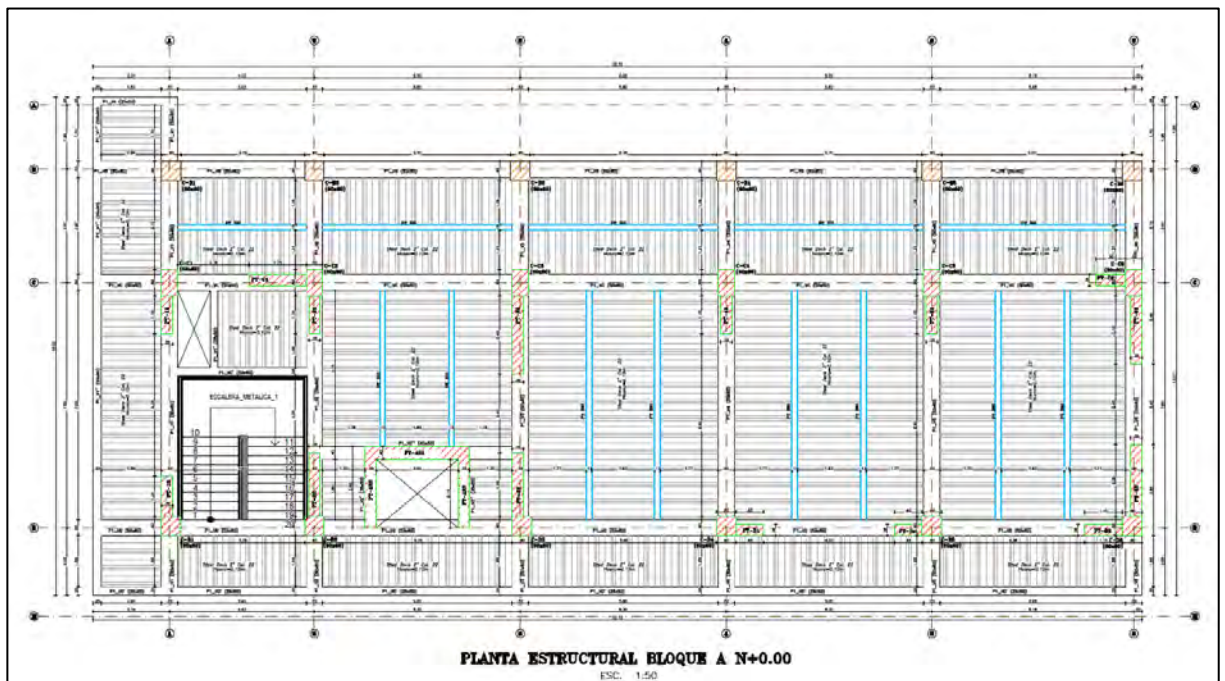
Planta estructural Bloque A, N+0.00. (Ver Anexo A)
